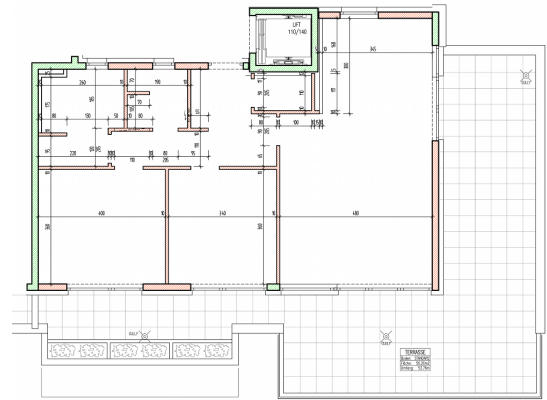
Grundriss (*mascil*-Team Austria)
